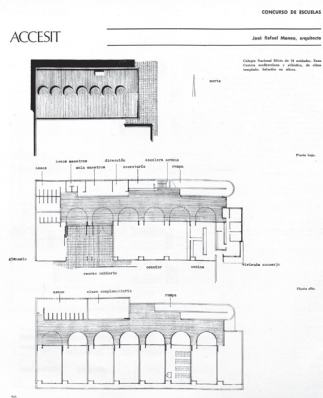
Concurso de Escuelas. Accésit. Rafael Moneo. Planta cubierta, planta baja, planta alta.
